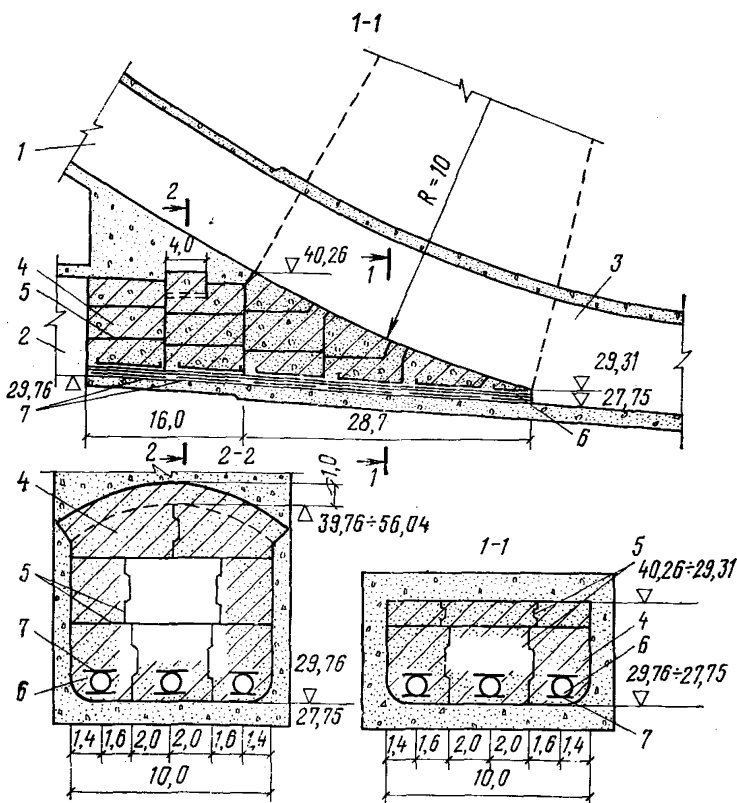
Бетонная пробка в узле сопряжения наклонного водовода со строительным туннелем:
